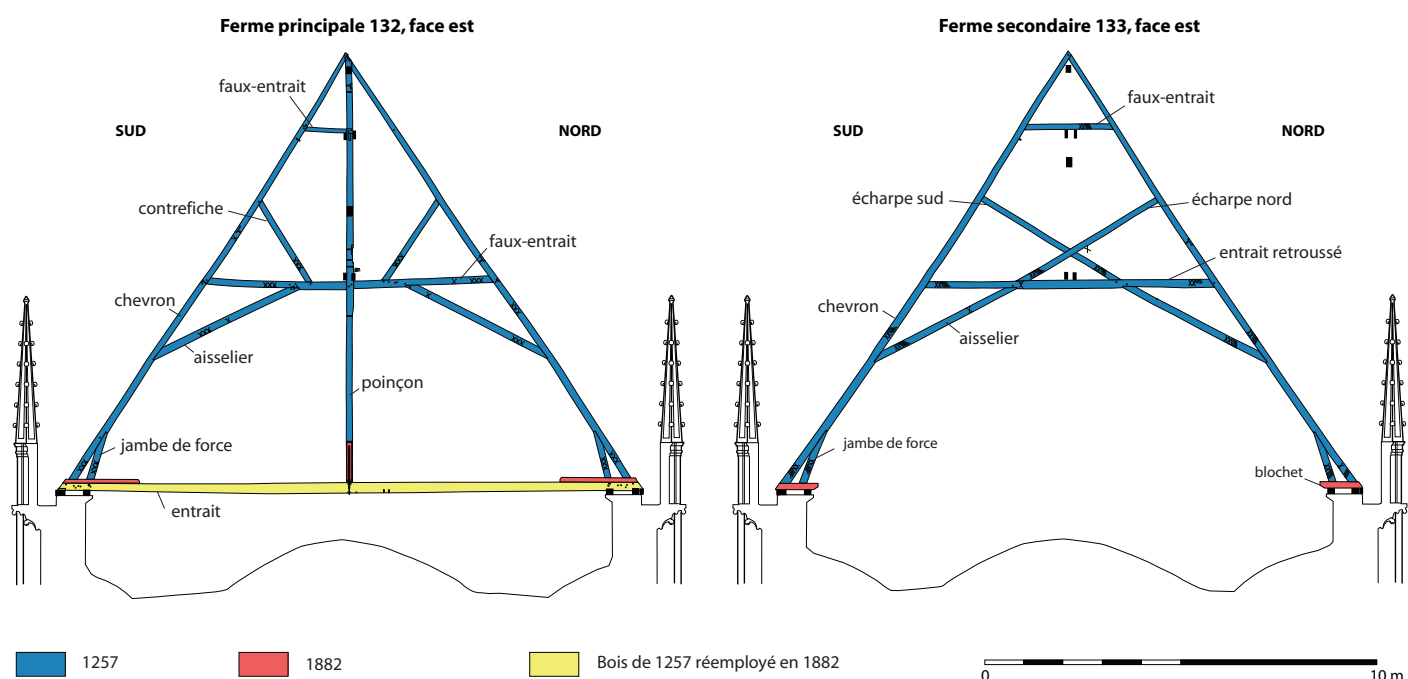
> Charpente du chœur, fermes principale 132 et secondaire 133, face est. [Relevé et DAO : F. Épaud.]
